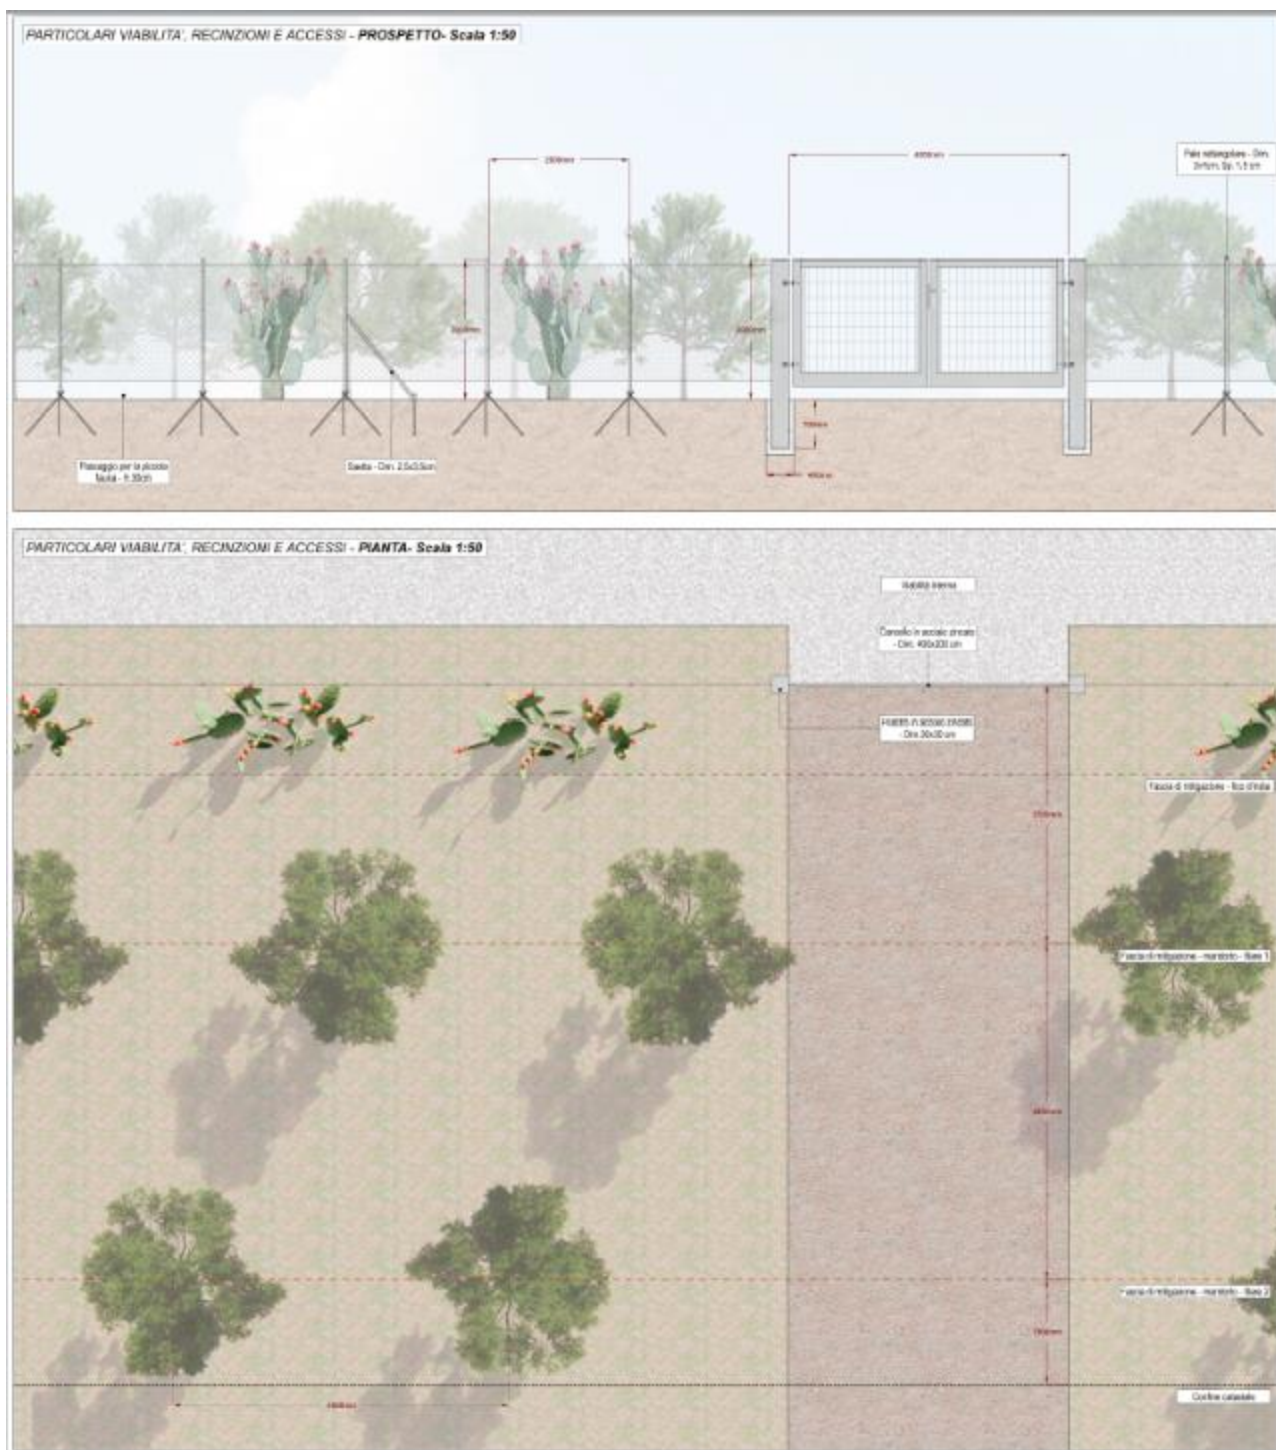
Area di mitigazione di tipo A, in sezione trasversale e in pianta
